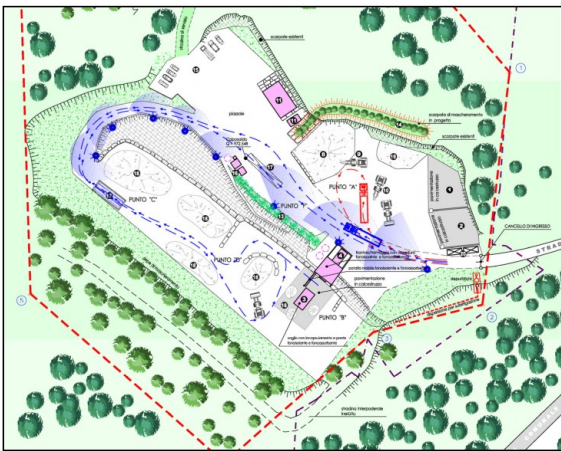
Planimetria dello stato autorizzato attuale dell'area di intervento
